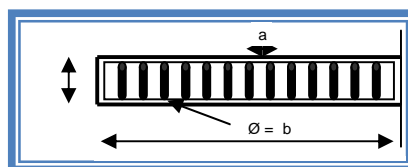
Rejilla – Planta (adaptado por López Cualla)²
